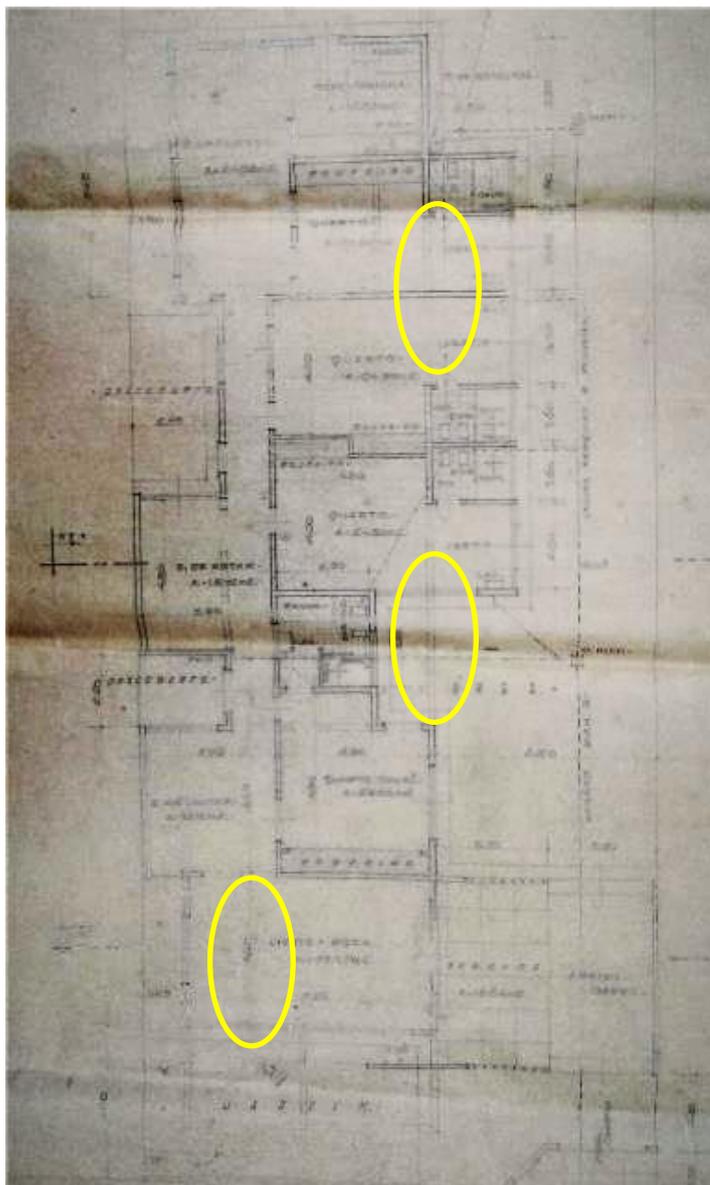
Casa Maria Deolinda - Planta Baixa original - 1956. Fonte: Acervo LAHCA.
